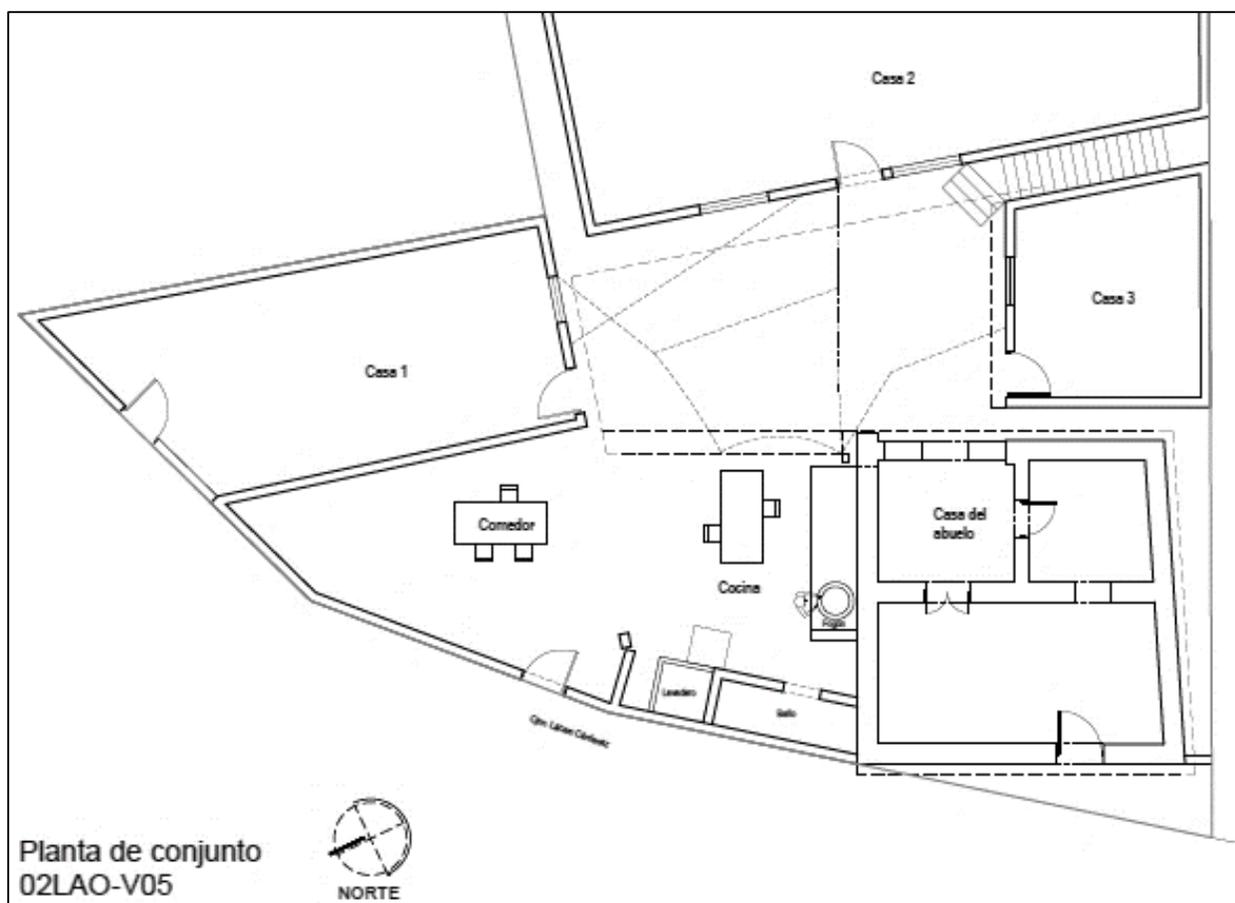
Planta de conjunto de vivienda en Laollaga. Clave:02LAO-V05. Fuente: elaboración propia.
